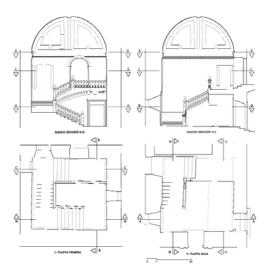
Proyecciones diédricas de la escalera: (a) Planta Baja y Sección A-A; (b) Planta Primera y Sección B-B (dibujo de la autora)
